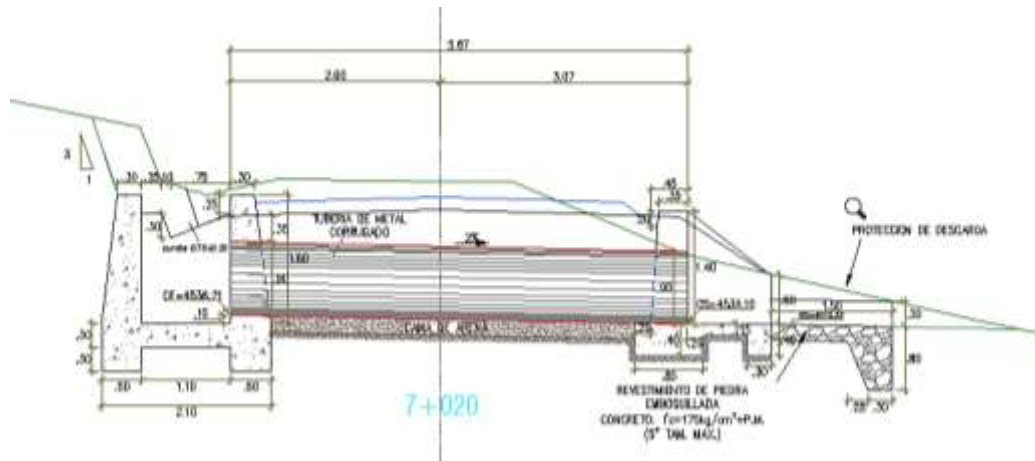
Alcantarilla de acero corrugado galvanizado. Fuente: Planos de secciones de alcantarilla.
